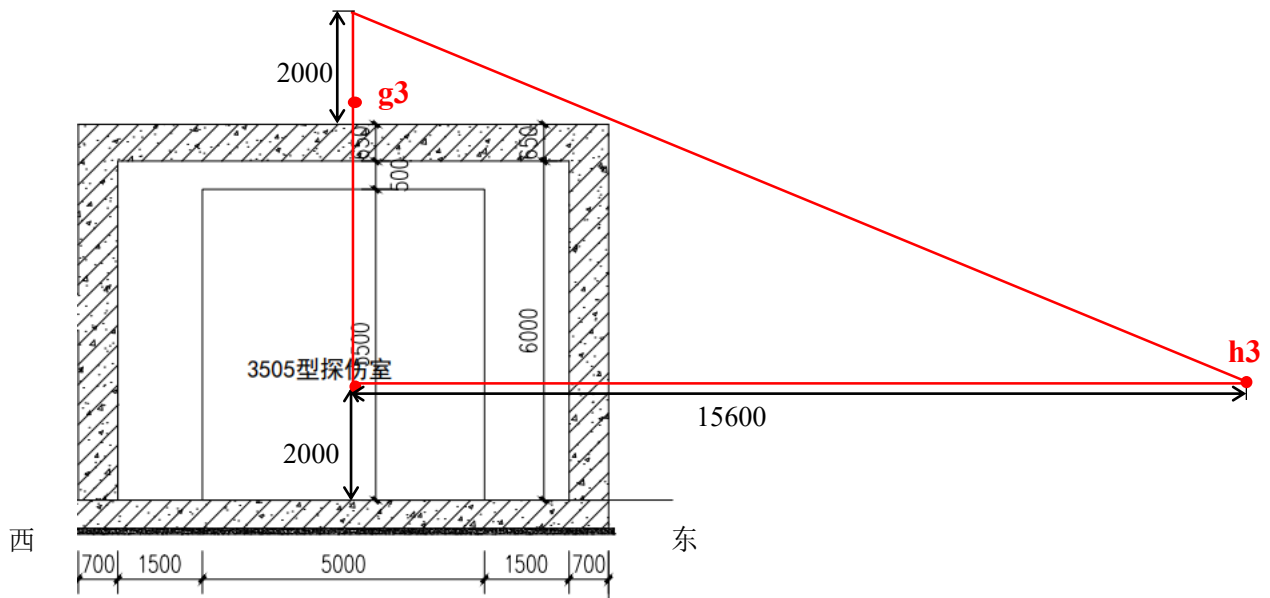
3号探伤室辐射屏蔽计算预测点位剖面图（单位：mm）
